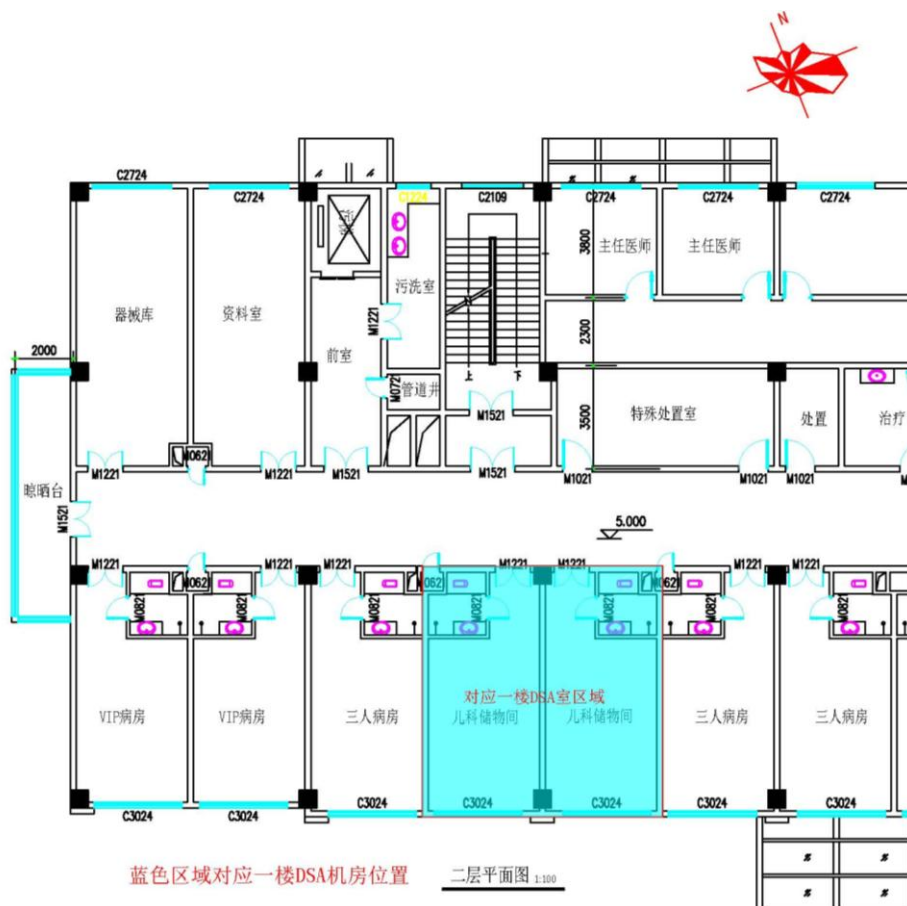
内科楼二楼平面布置图局部（蓝色阴影区域对应 DSA 机房）
